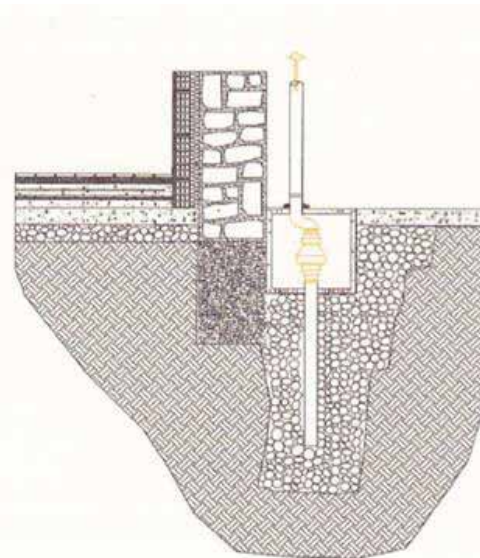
Schema di pozzetto d'aspirazione esterno, adiacente al perimetro dell'edificio
